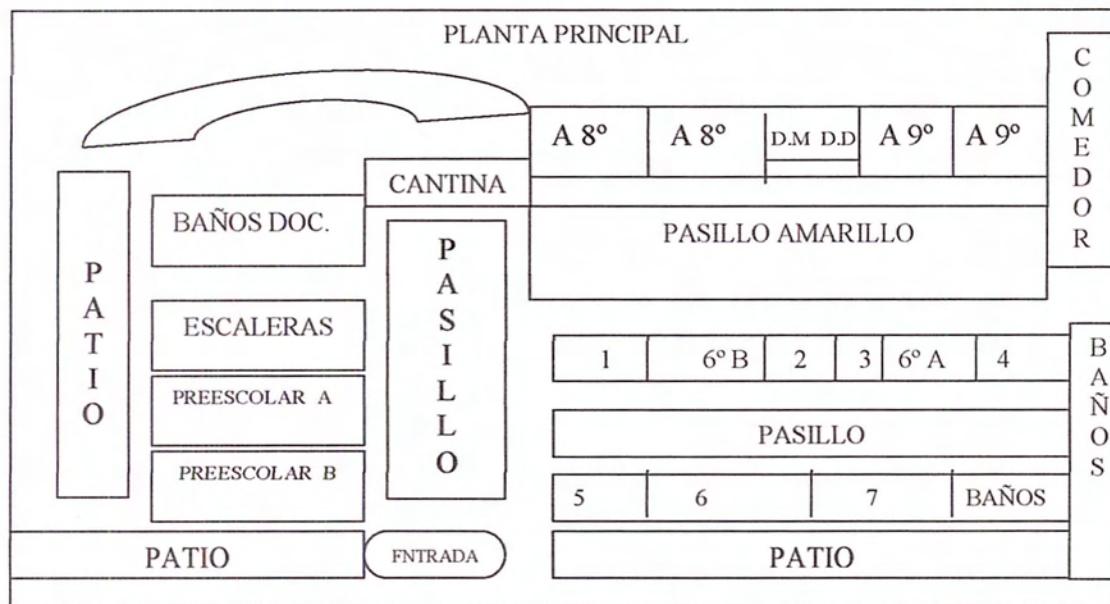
Estructura planta baja de la E. B. "Américo Briceño Valero"
